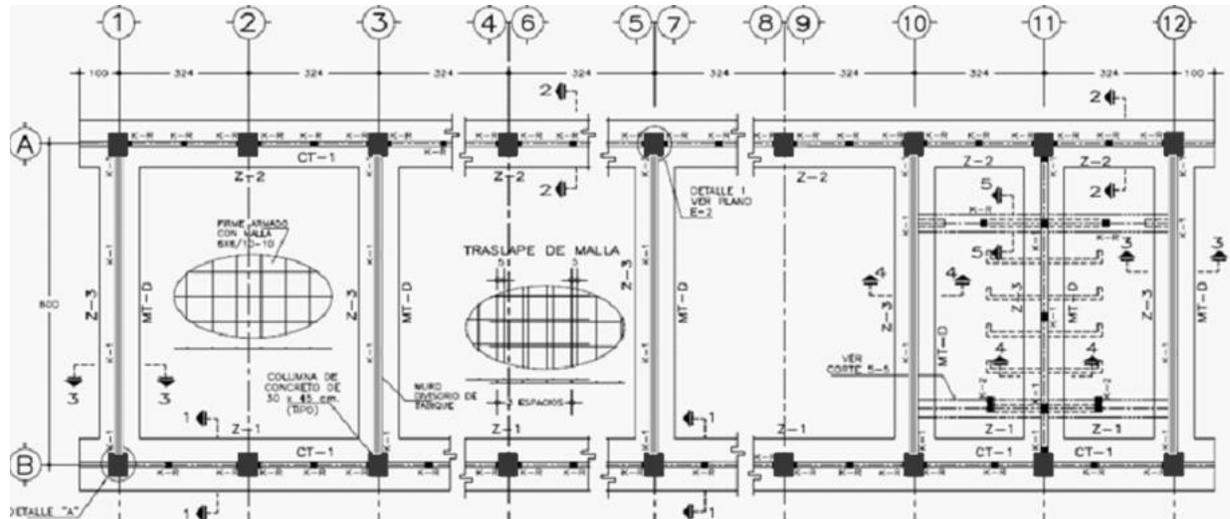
Planta de Cimentación. Fuente Planos E-1, U-1C, INIFED (*Educativa I. N.*, 2015)
